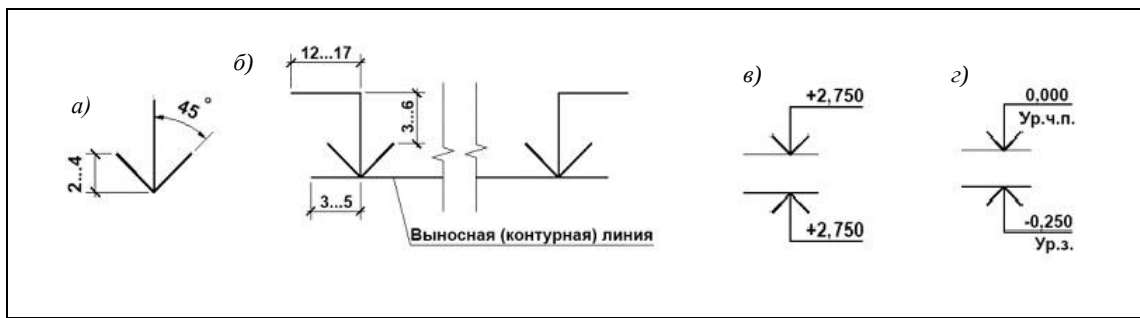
Нанесение высотных отметок на чертежах фасадов и разрезов:
